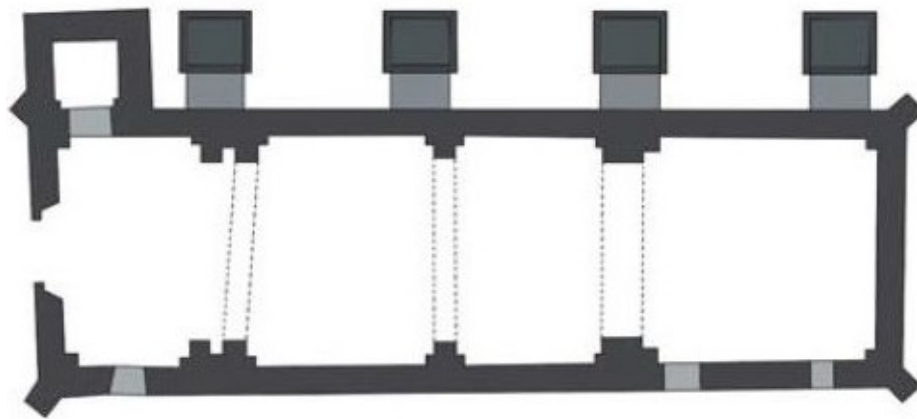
Vista en planta del templo de Tetela [Zapata, 2014]
